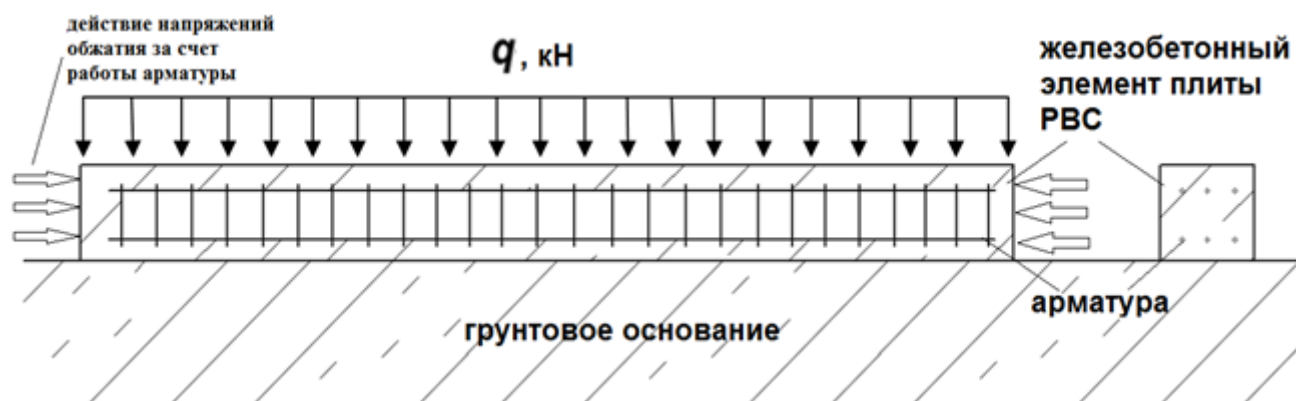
Структурный элемент в виде железобетонной балки, выделенный из плитного фундамента резервуара
